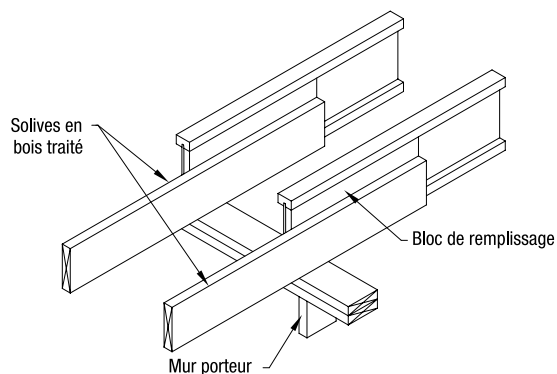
• Balcon avec poutrelles et solives en bois traité
